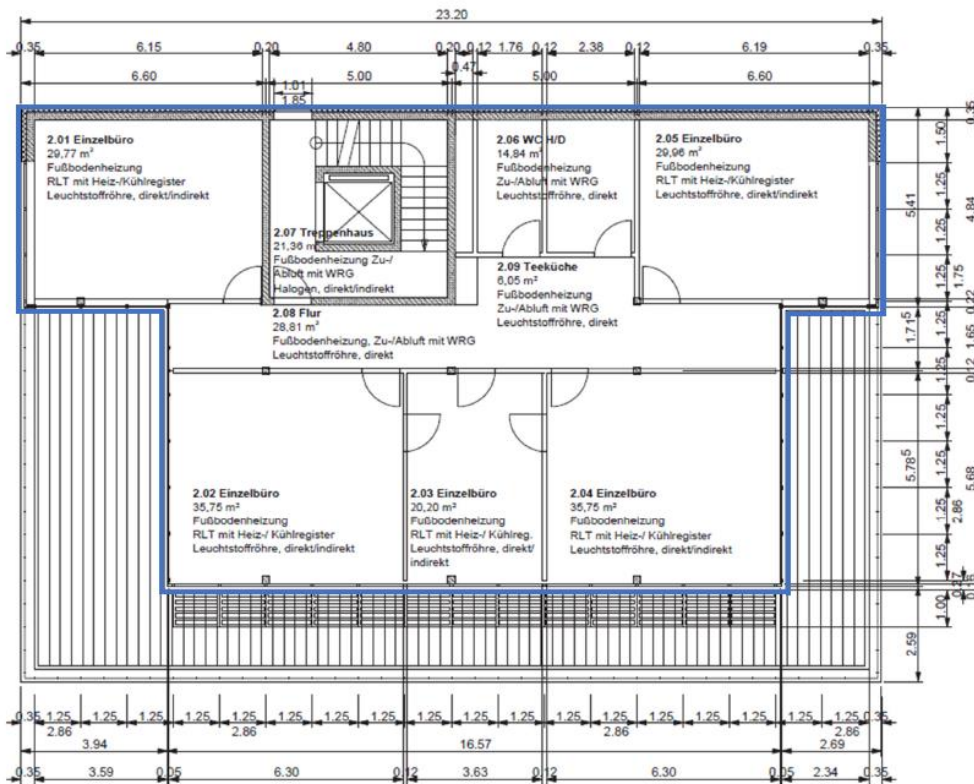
Beheiztes Volumen – Dachgeschoss.
